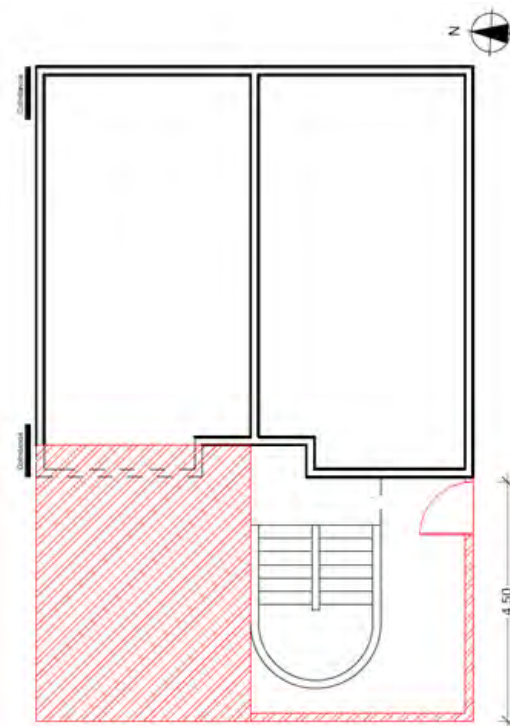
Planta del Edificio D indicando el área intervenida por modificación.
